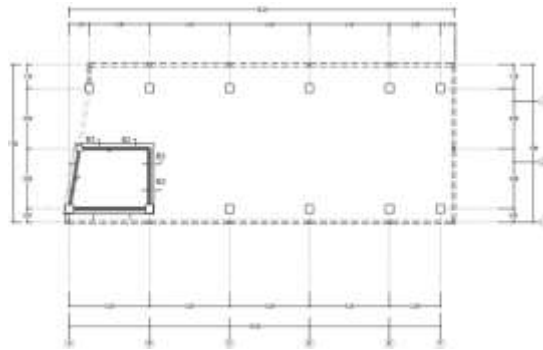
Denah perencanaan awal balok lantai atap tangga.
